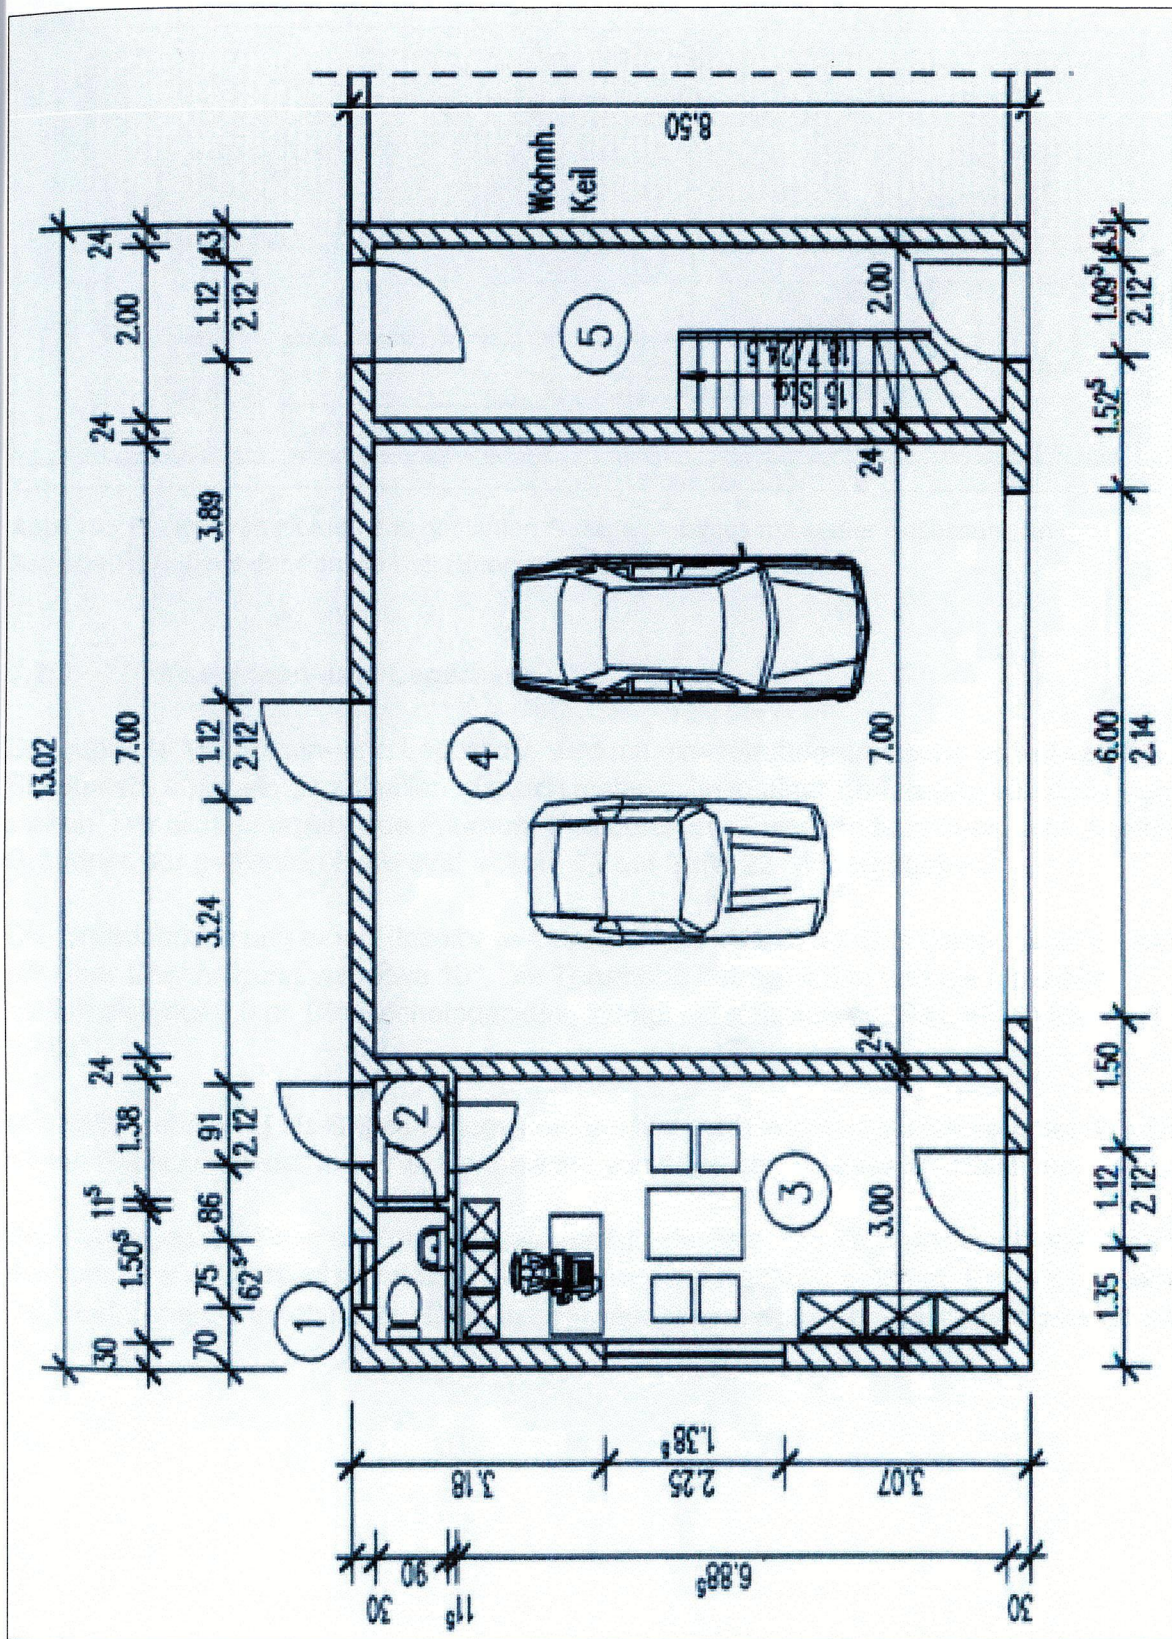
Grundriss (Erdgeschoss) des geplanten Garagenanbaues am Betriebswohnhaus der Familie Keil (*Entwurf: Udo Rank*).
